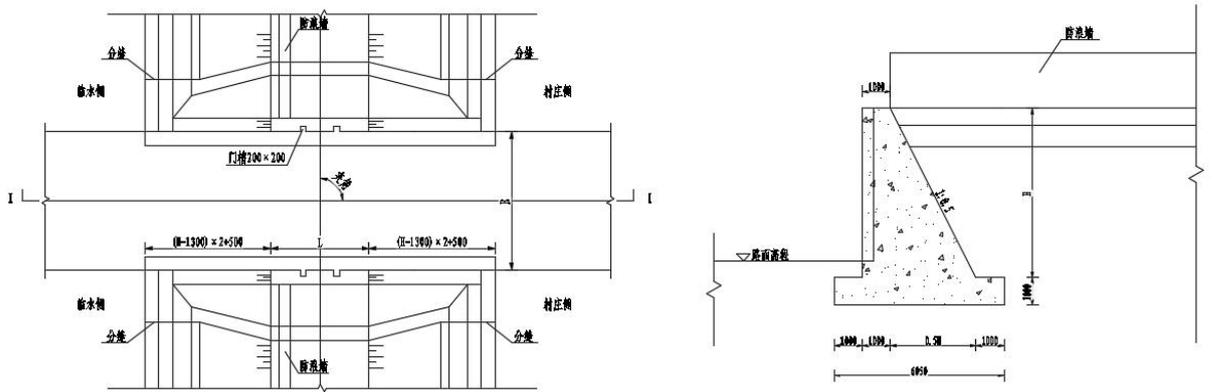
围村堤 B 型路口闸挡墙立面及断面图
